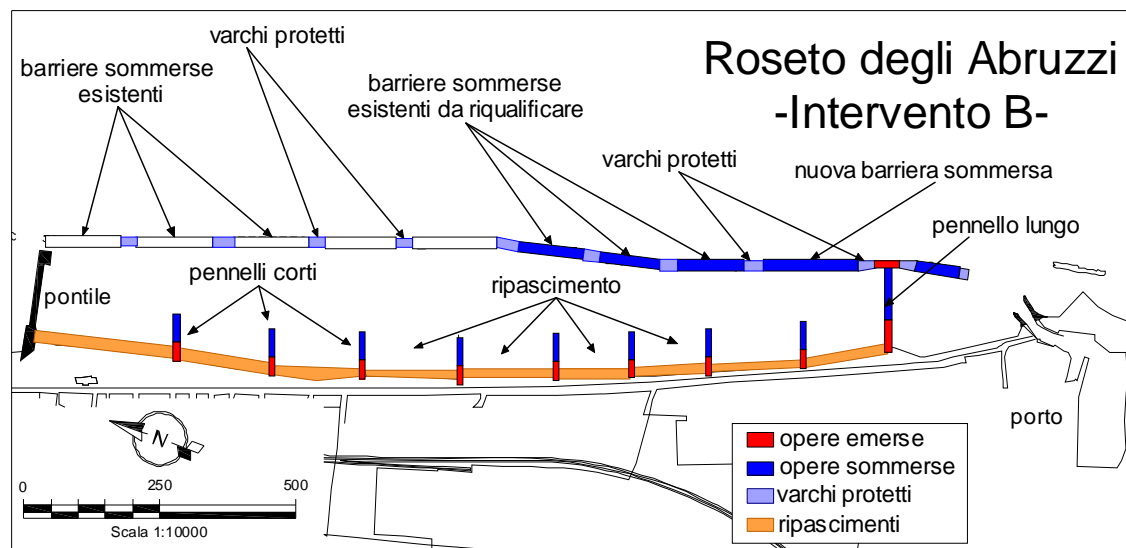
Roseto Progetto Preliminare Generale, descrizione intervento B.
